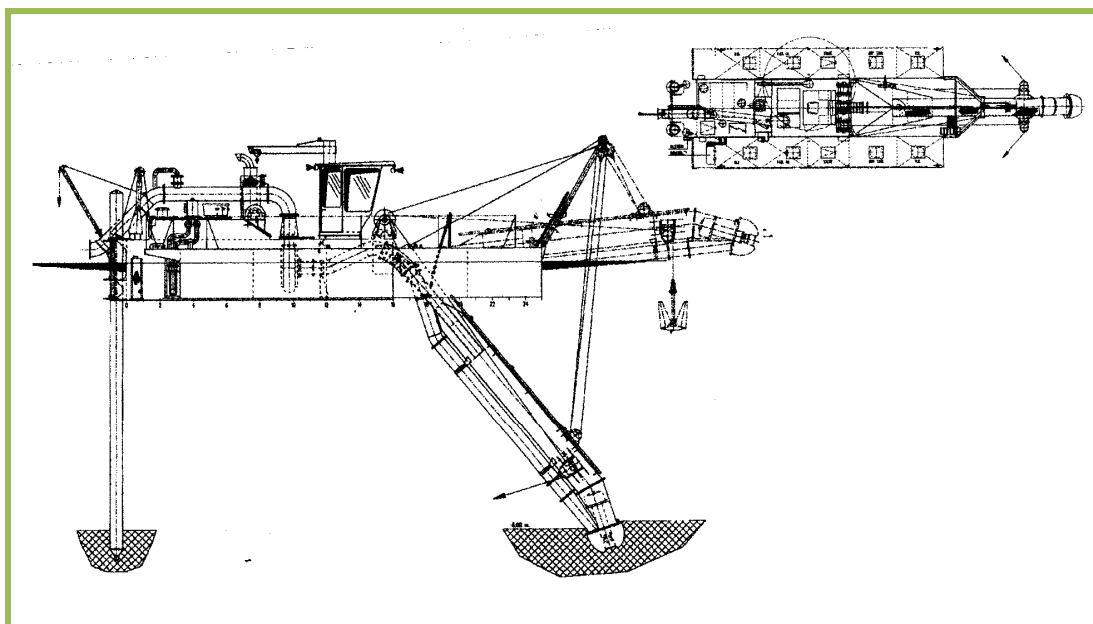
Equipamento – planta baixa e vista.
